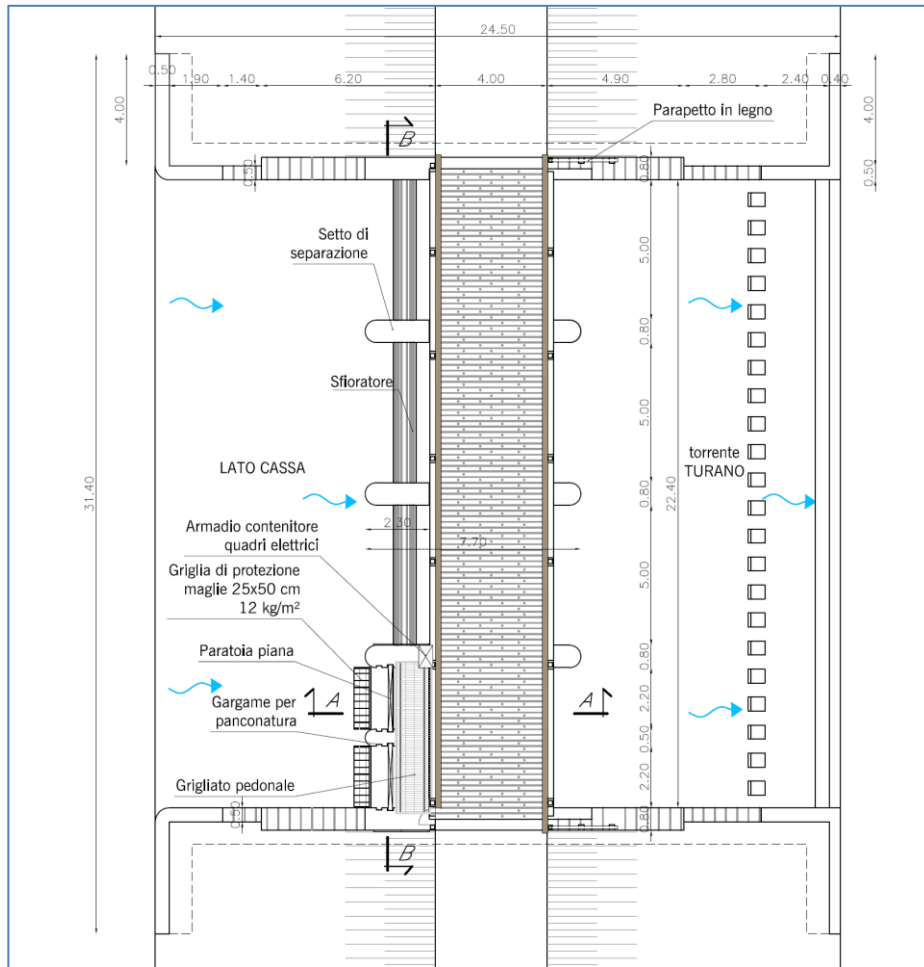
Cassa sul T. Turano. Pianta del manufatto di restituzione.
